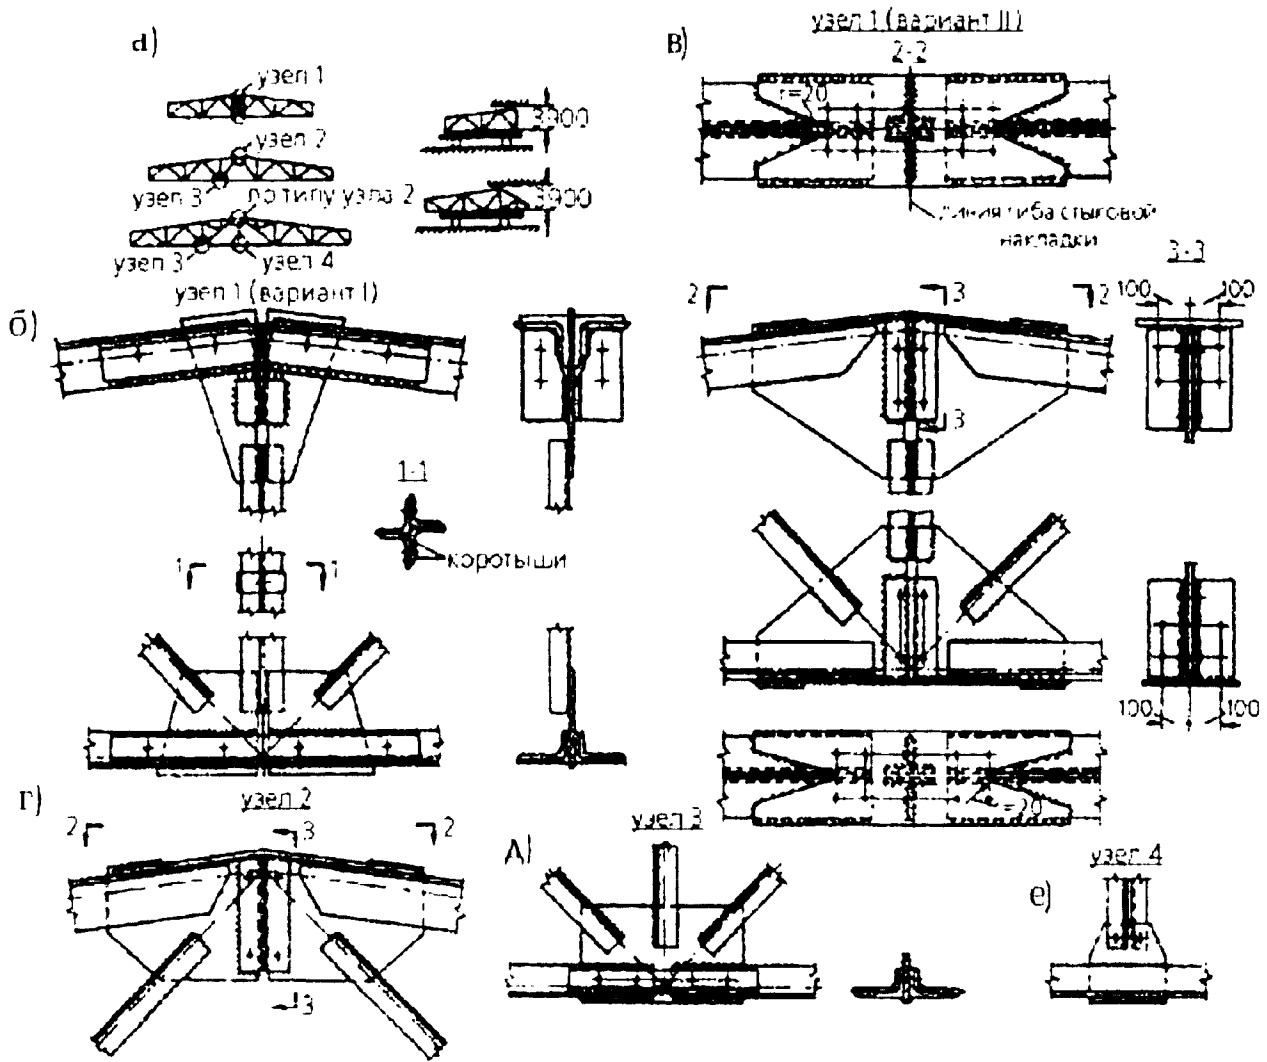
Укрупнительные узлы ферм: а - схемы ферм и положение их при перевозке; б-е - укрупнительные узлы
